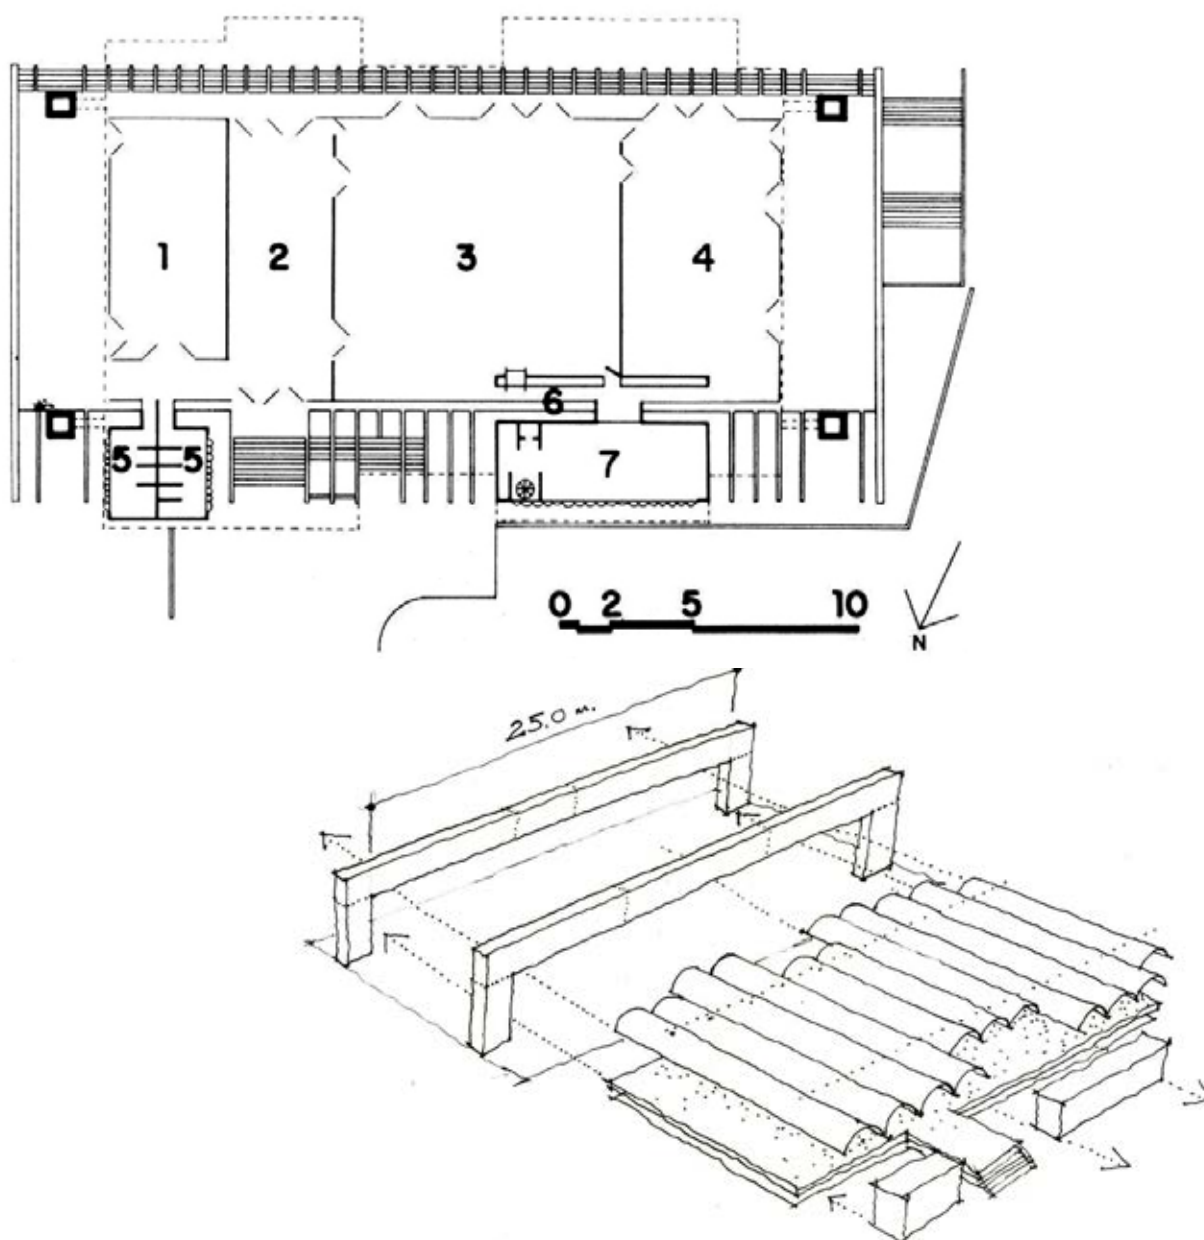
planta térreo Pavilhão da Piscina: 1) salão de jogos; 2) hall; 3) salão de festas; 4) restaurante; 5) sanitários; 6) buffet; 7) cozinha.
